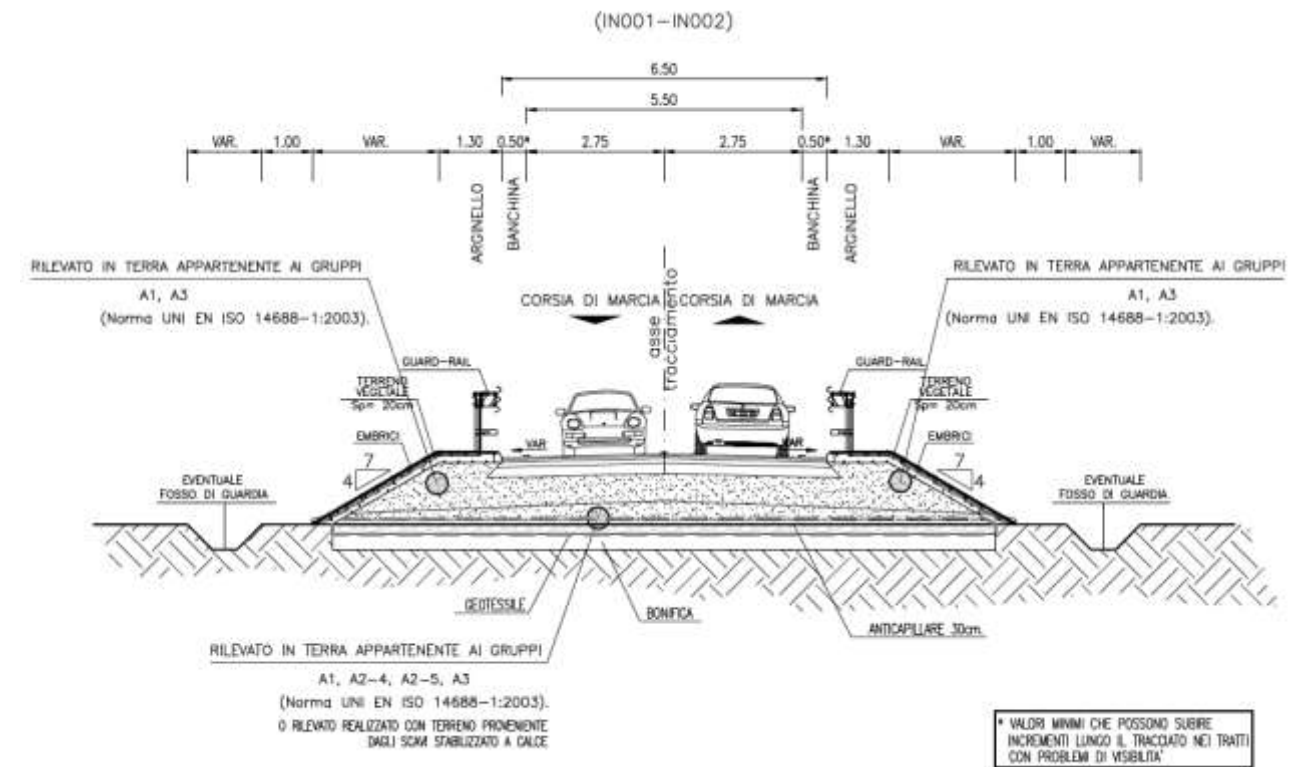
Sezione tipo poderale in rilevato
